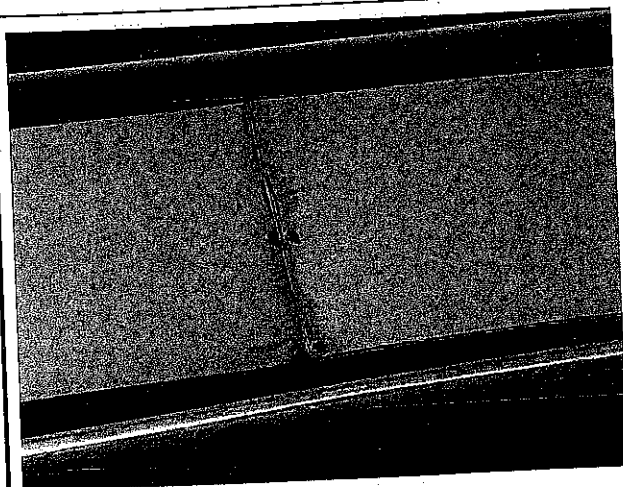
au droit des joints, les fixations et les recouvrements sont mal assurés.
